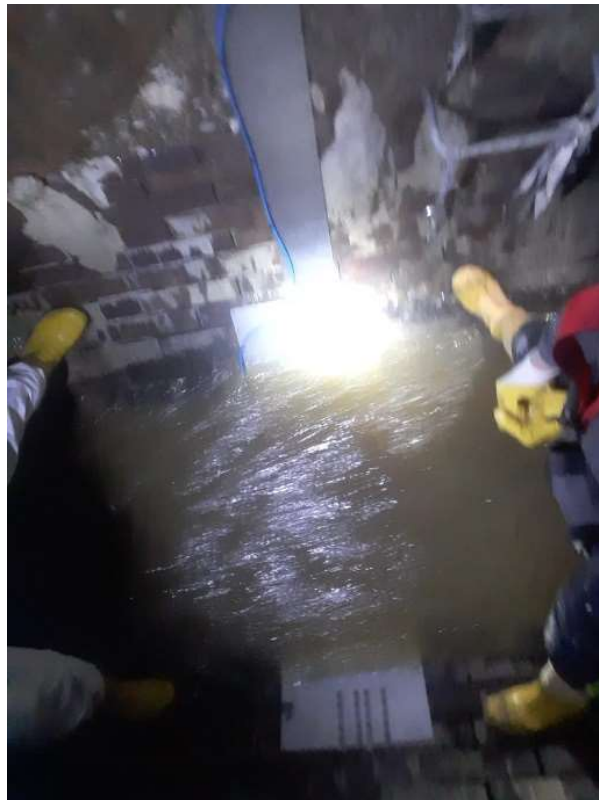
Montageblech mit Sensor im Kanal montiert
